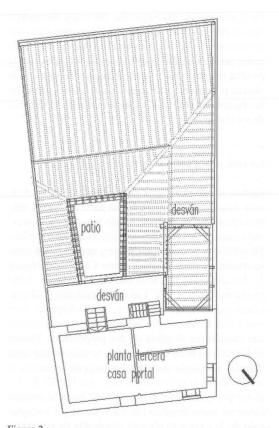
Planta bajo cubierta, situación de la armadura en la planta de la casa (dibujo del autor 2013)
